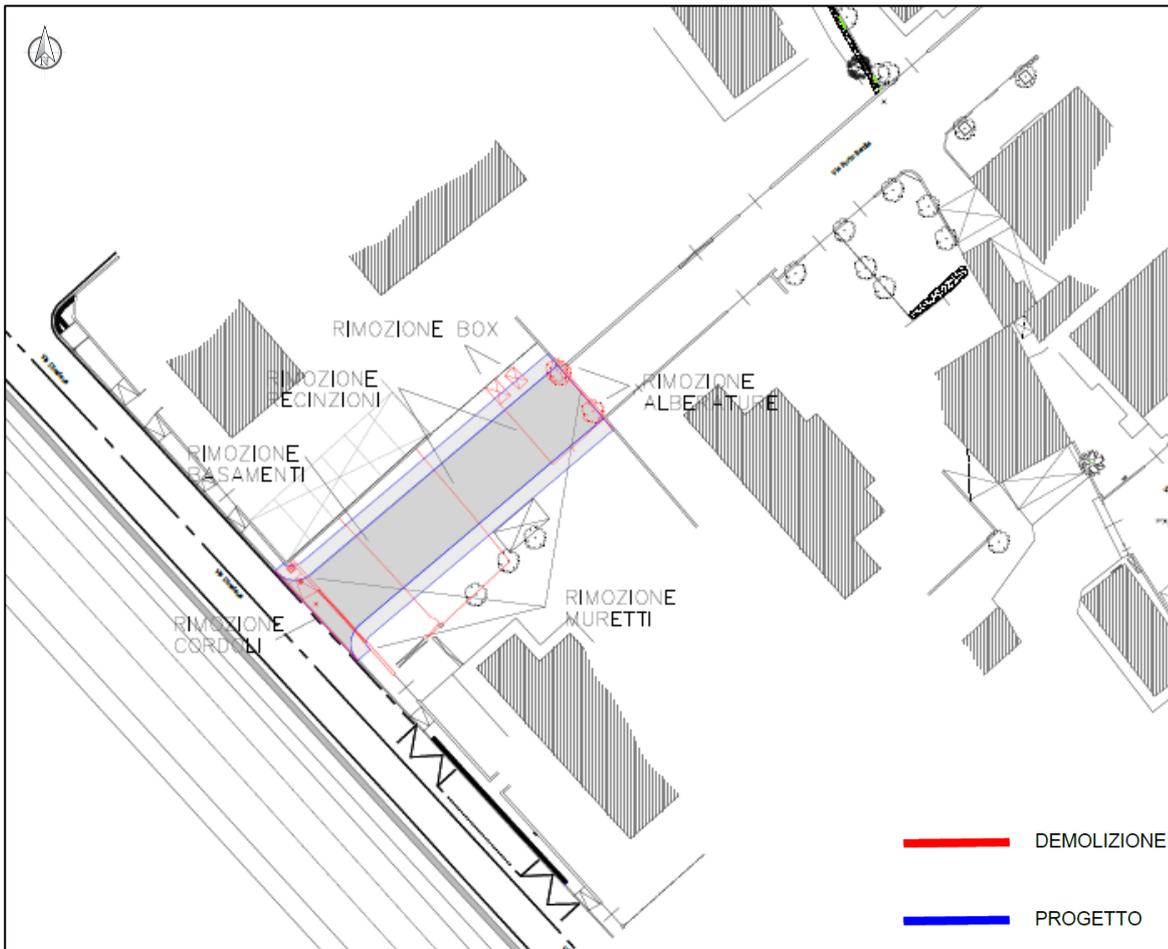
d – estratto della tav. 03 di progetto con identificate le opere in demolizione e di progetto
